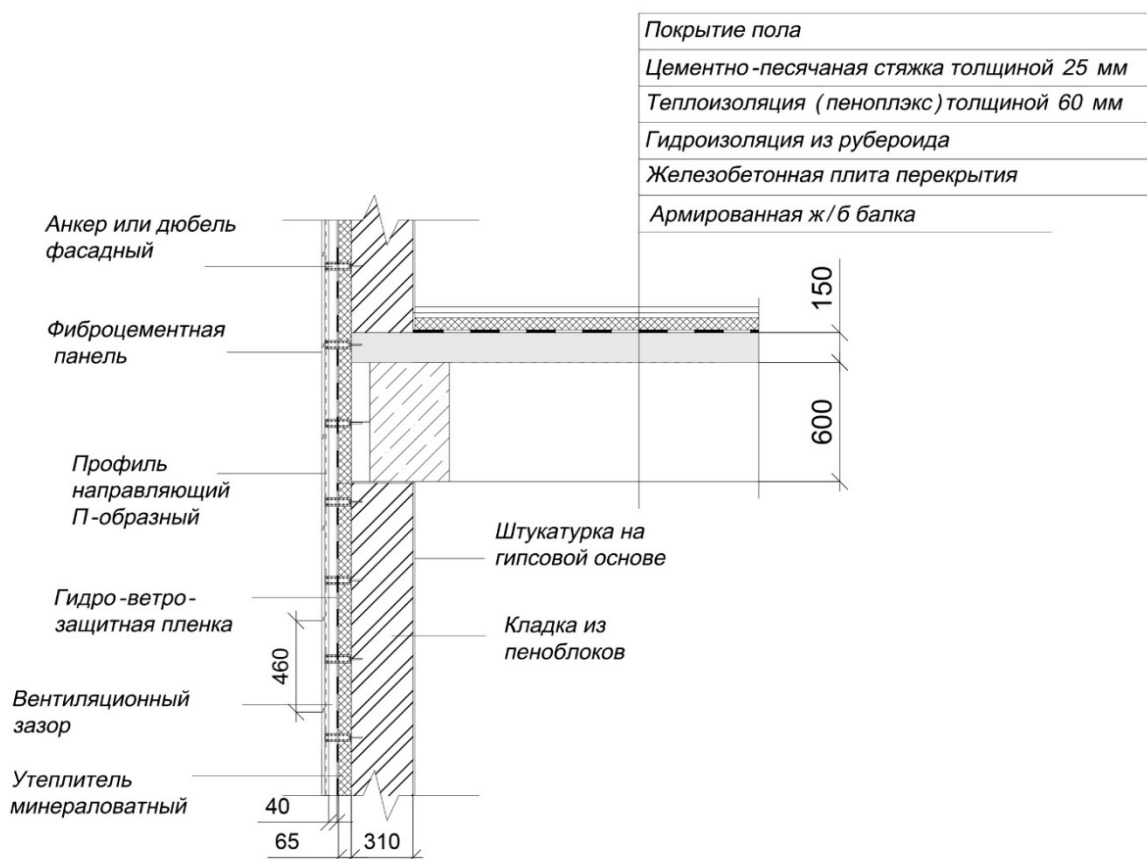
Узел примыкания наружной самонесущей стены с монолитной плитой перекрытия.
